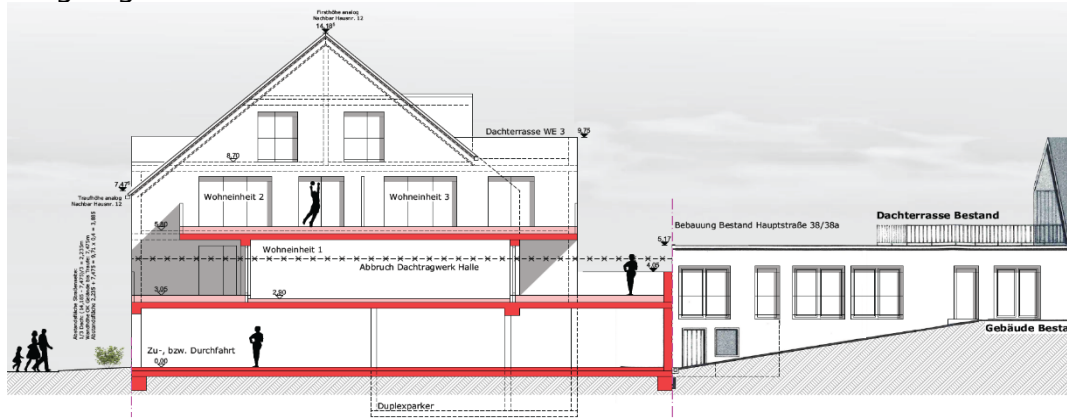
Querschnitt durch das geplante Gebäude, [REDACTED] v. 08.12.2025
